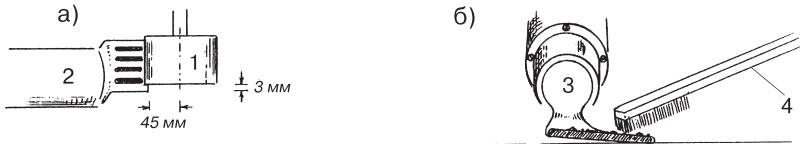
а) Расположение прикаточного ролика (1) и сопла (2);
